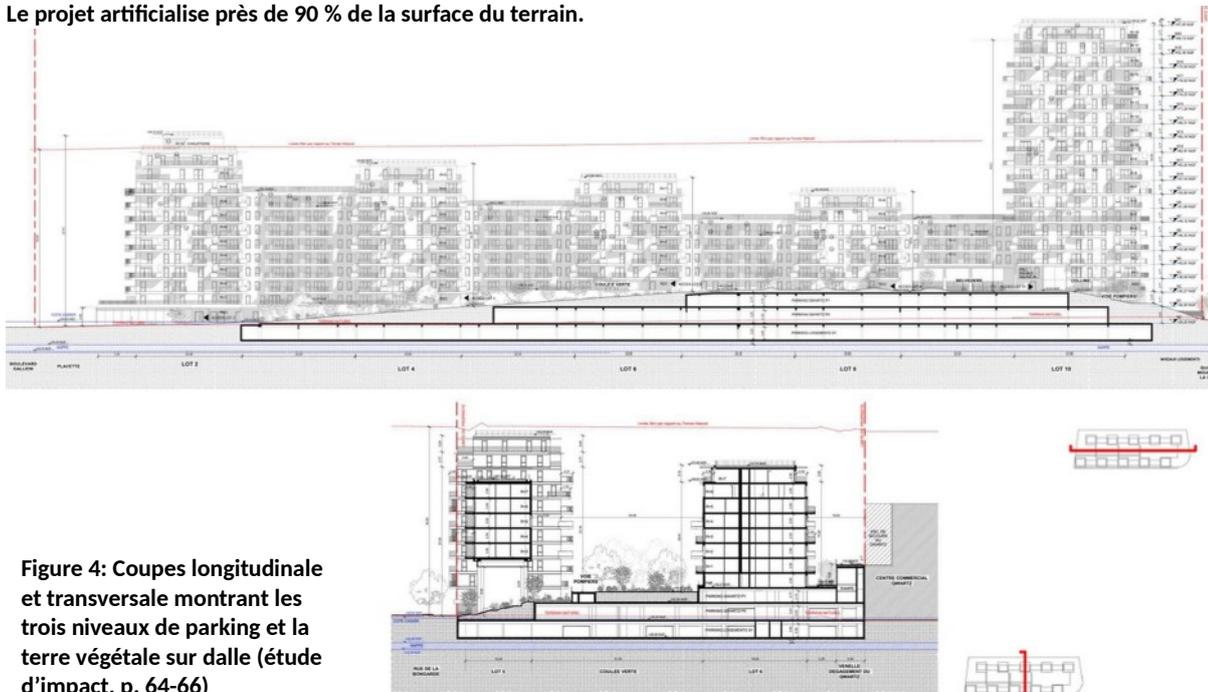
Coupes longitudinale et transversale montrant les trois niveaux de parking et la terre végétale sur dalle (étude d'impact, p. 64-66)
